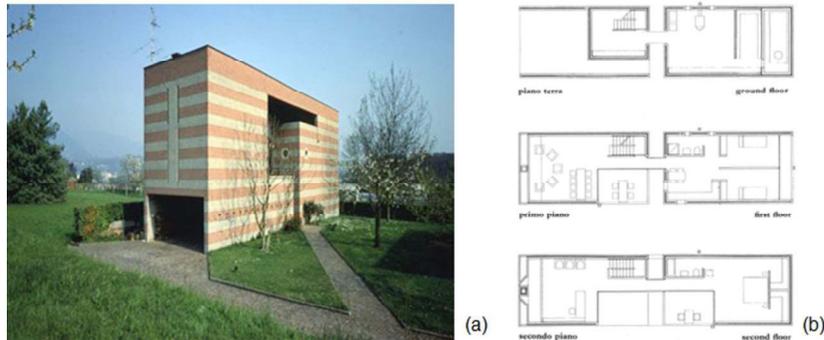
(a) Mario Botta, Casa de Ligornetto, Ticino, Suiza, (1975-1976): (a) Vista exterior fachada principal, (b) Planta baja, Primera planta y Segunda planta.
